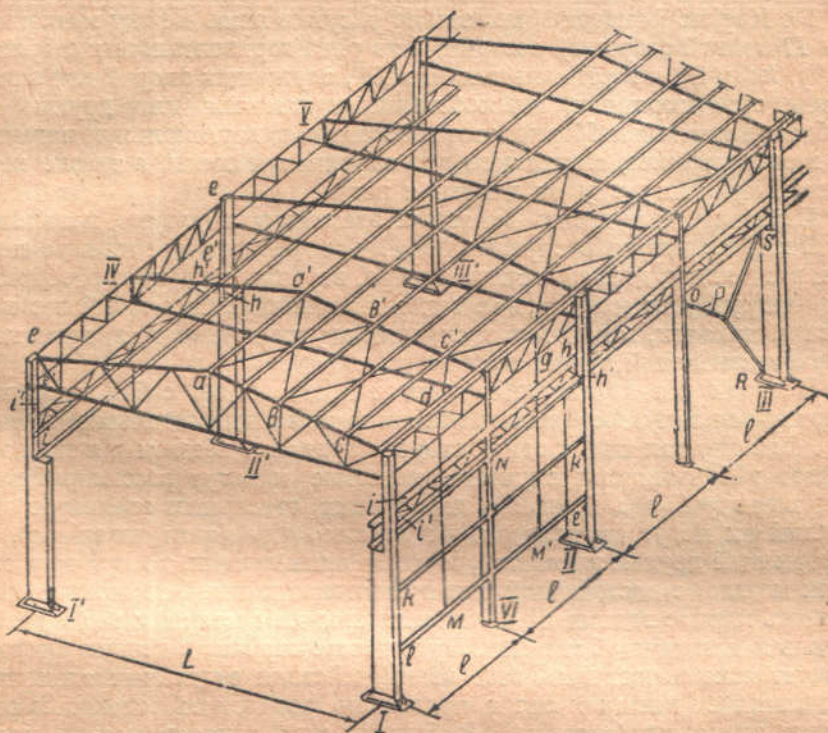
Обрешетины кровли и скатные связи в левой части кровли не показаны. Раскосы и стойки стропил показаны только в первой (торцевой) ферме; каркас фахверка показан только между I и II колоннами правой стены.
